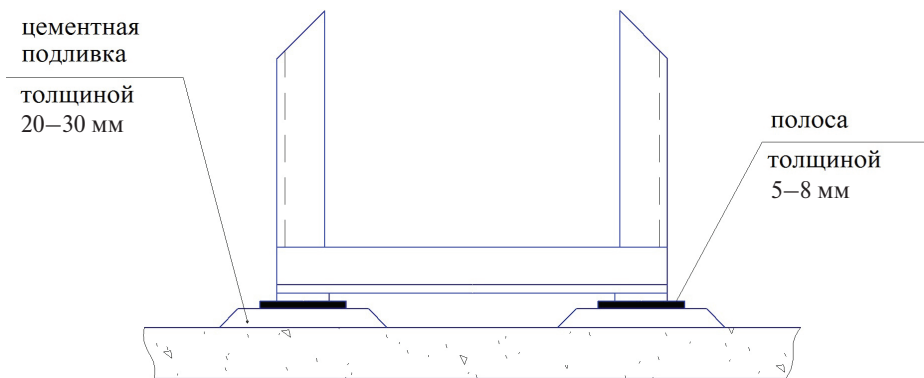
Компенсатор стандартных допусков в виде металлической полосы
